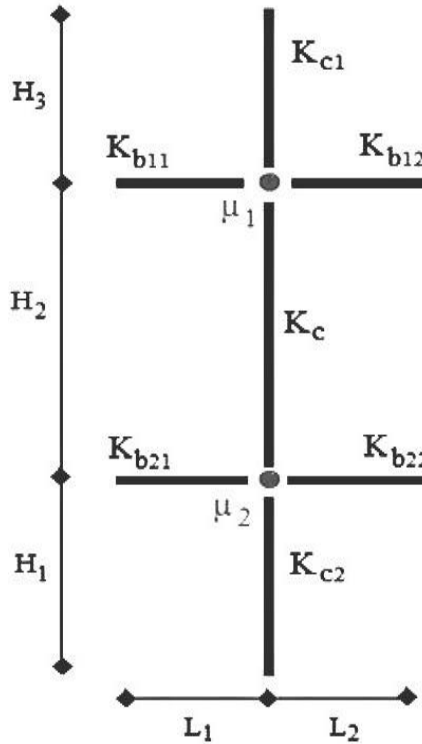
La rigidité (ou raidisseur) du poteau concerné.
